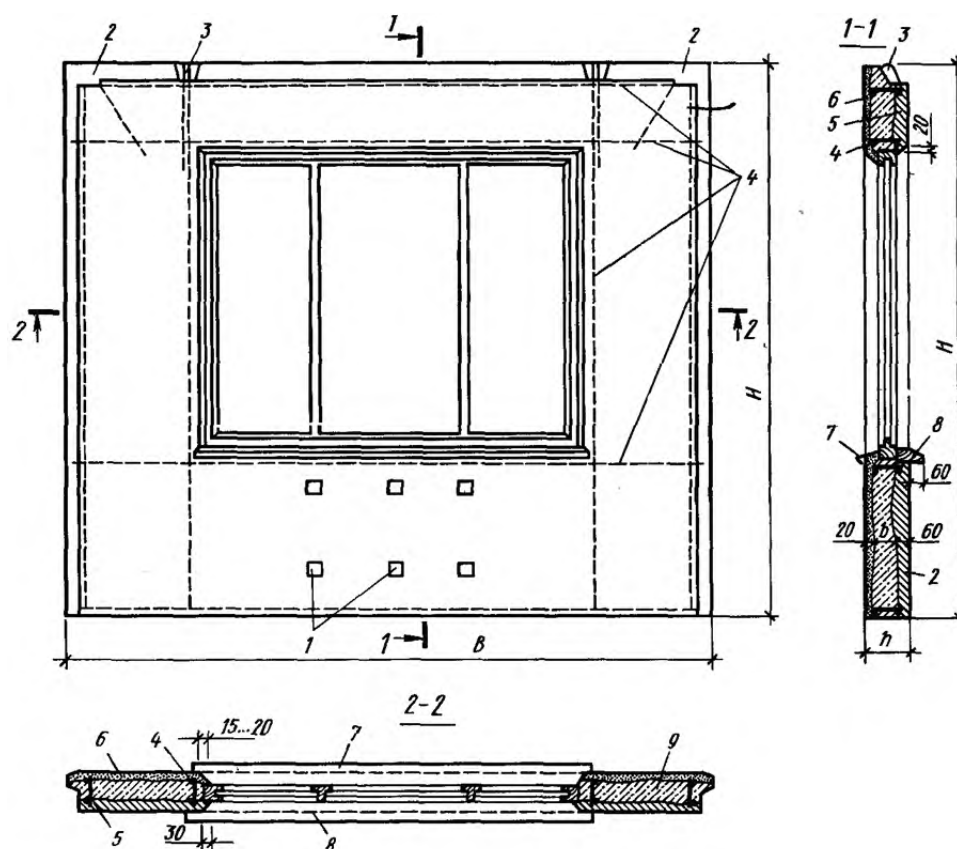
Двухслойная стеновая панель из легкого бетона:
